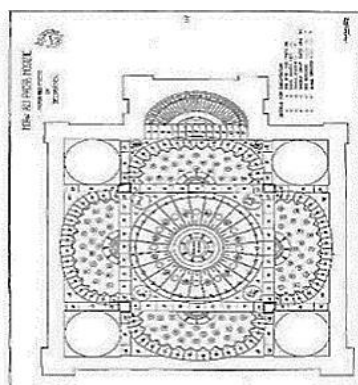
مسقط أفقي لجامع السليمانية ضمن مجمعه بأدرنة
